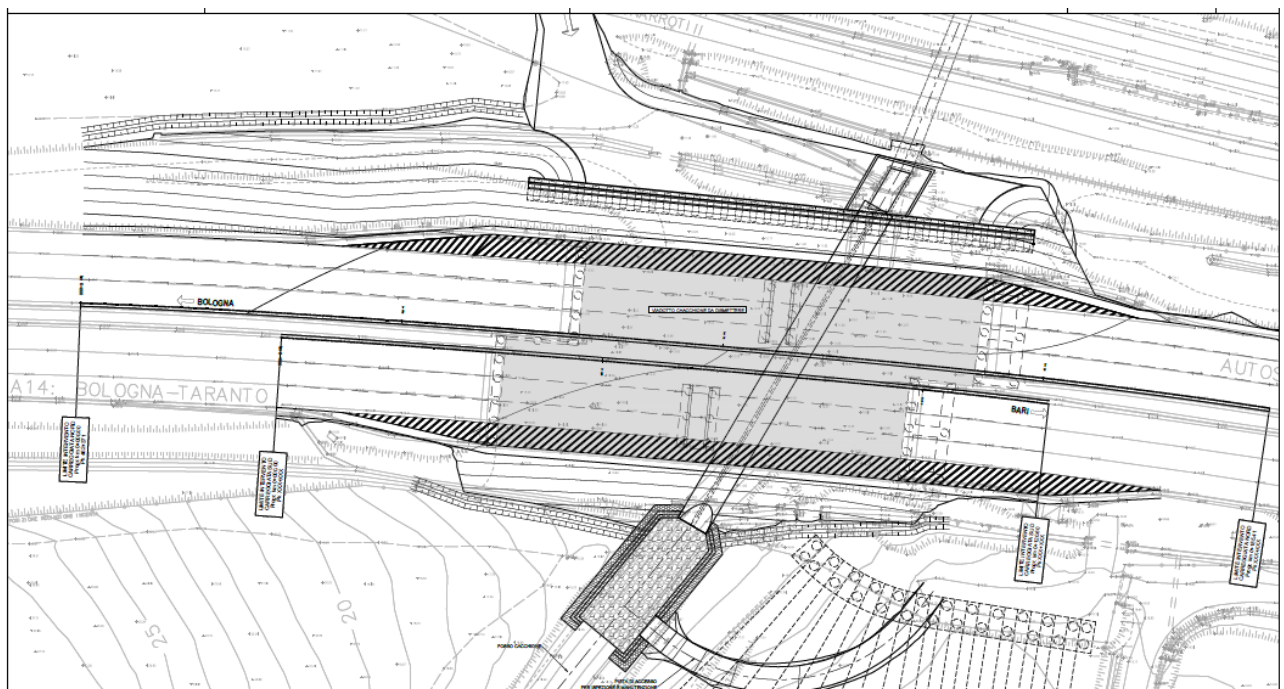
Planimetria di progetto del nuovo rilevato stradale con indicazione dell'attuale viadotto (in grigio)
